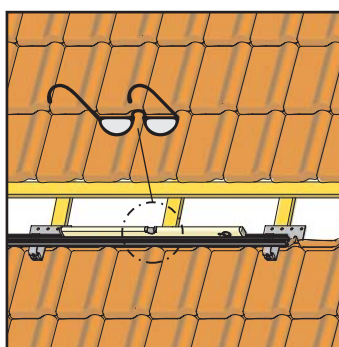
Alignez les profilés parallèlement au bord des tuiles
